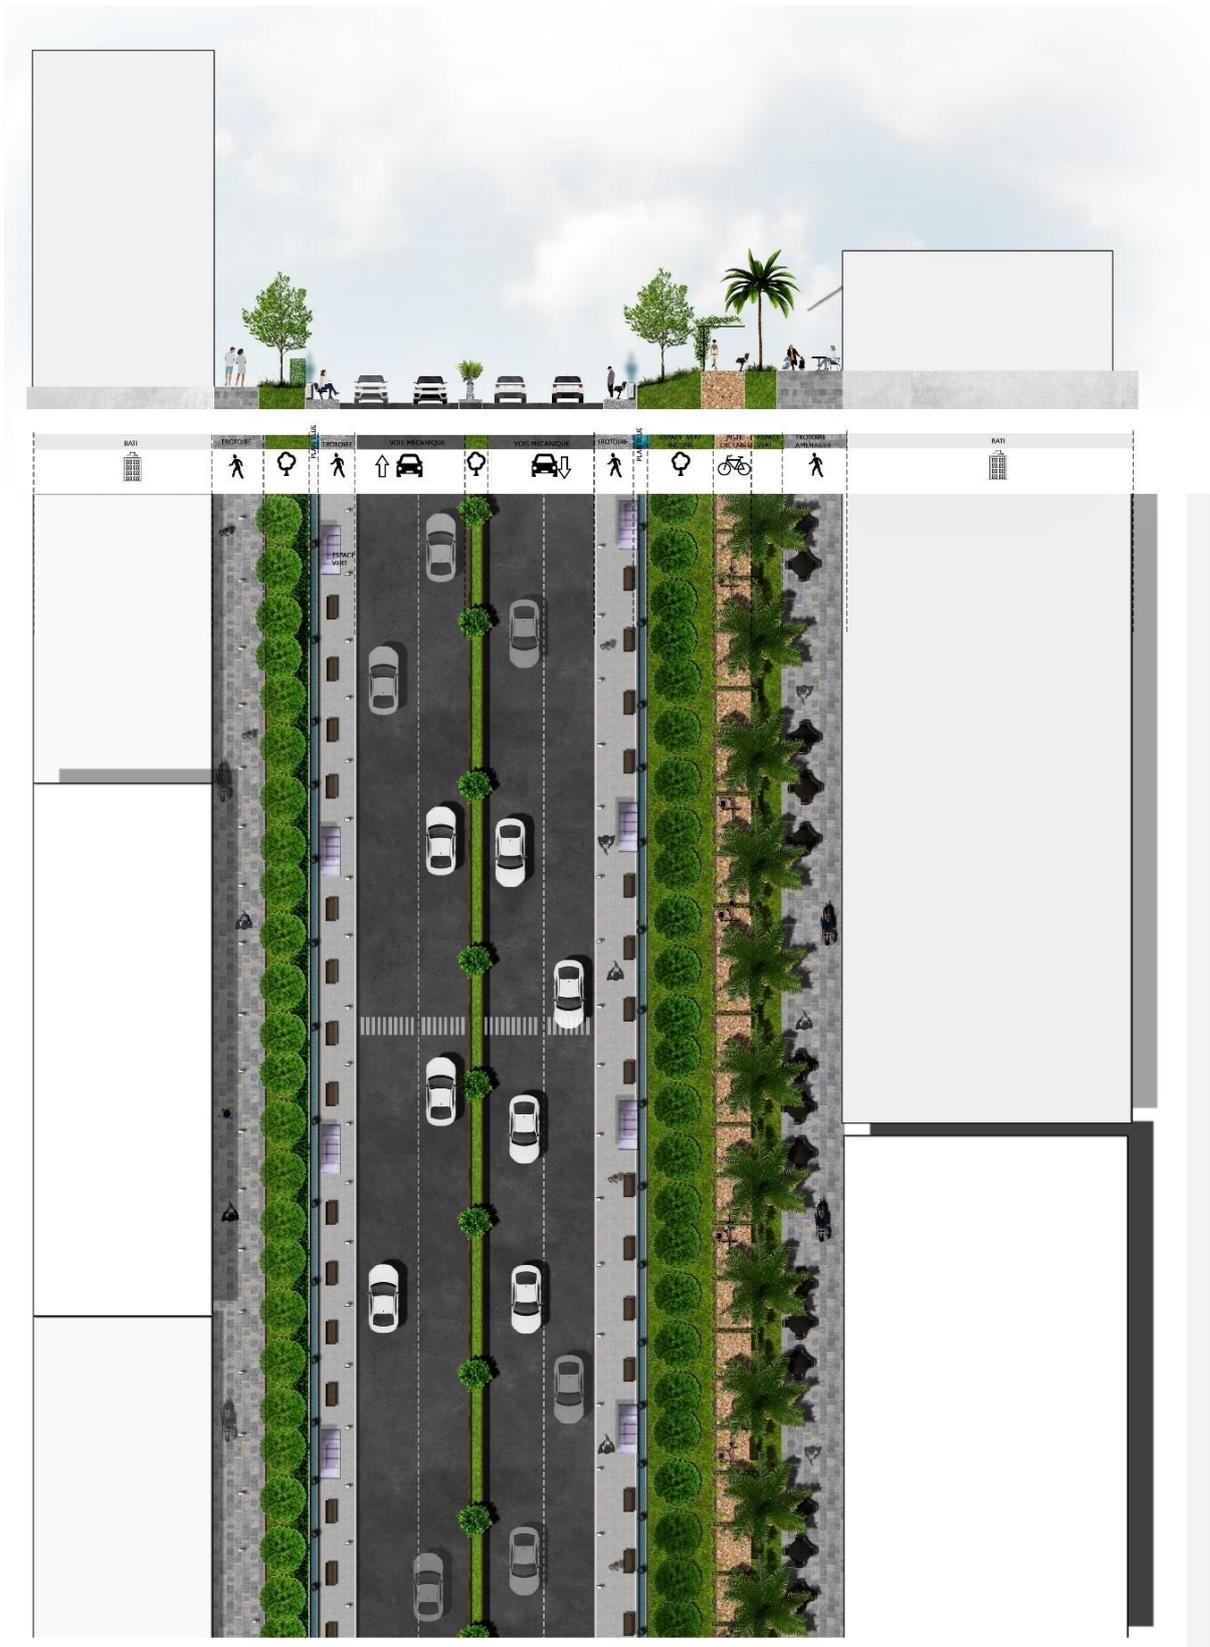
COUPE ET VUE EN PLAN DU BOULEVARD APRES L'INTERVENTION
